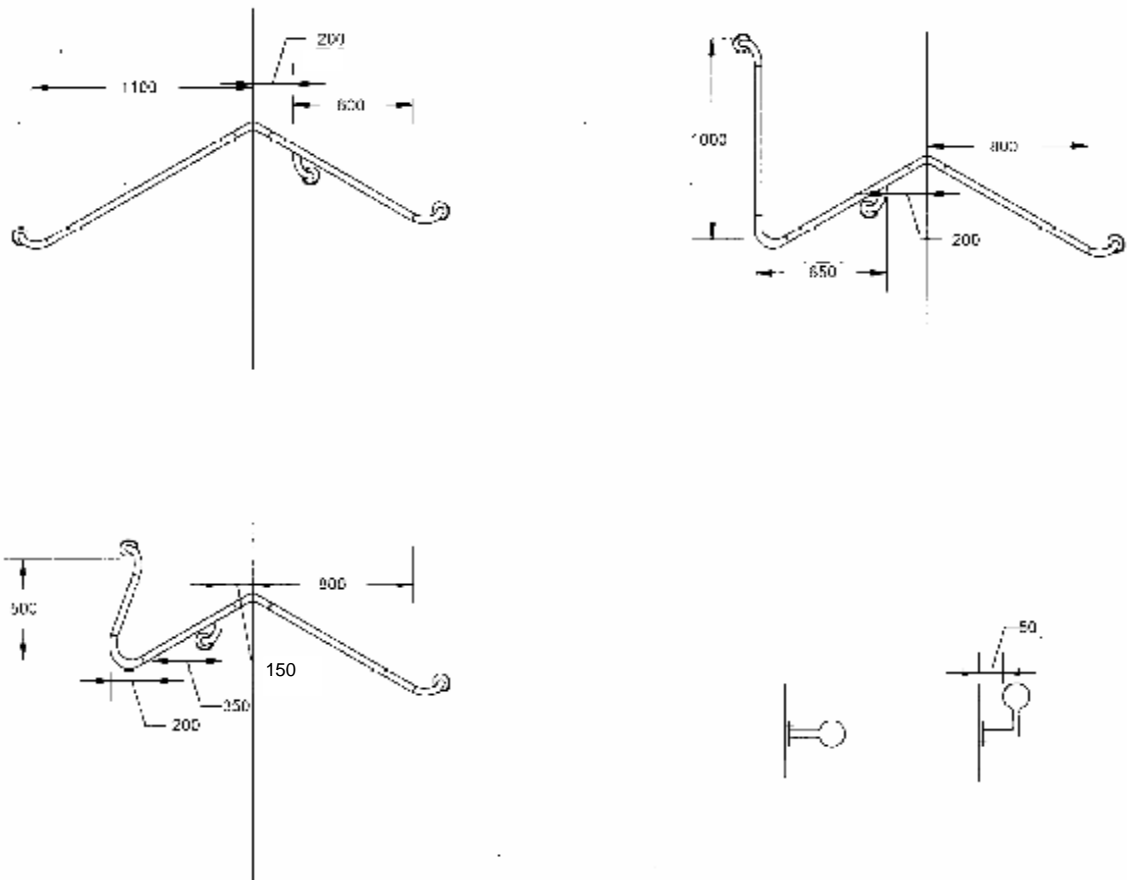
Barras de apoyo. Tipos. (Dimensiones en mm)
